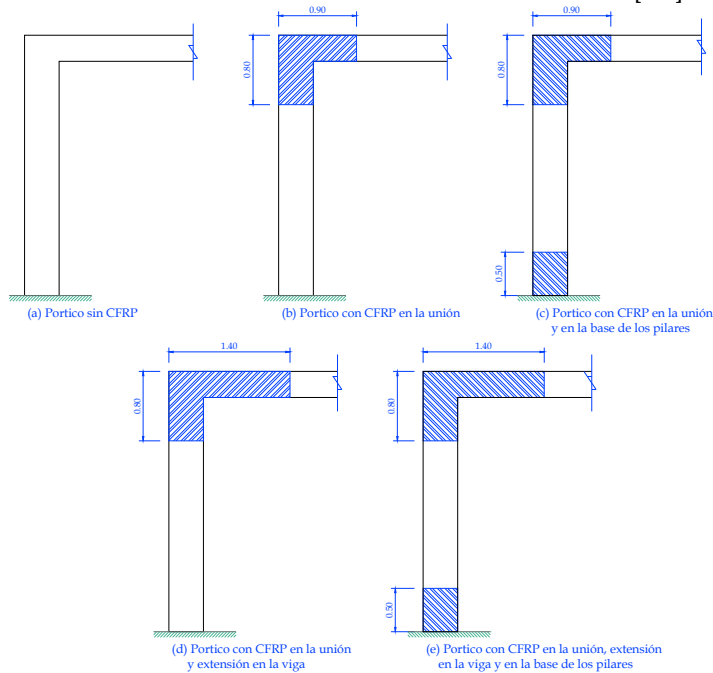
MODELOS DE LOS PÓRTICOS CON LAS CONFIGURACIONES DE REFUERZO [107]
